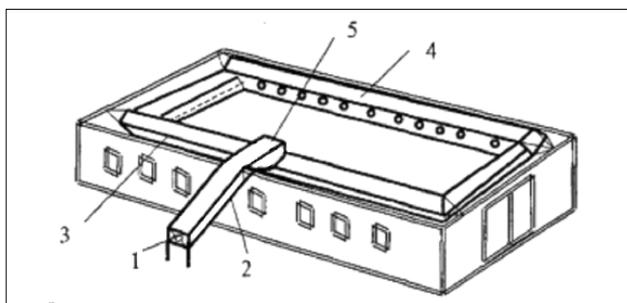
Система установки вентиляции в животноводческом помещении: 1 – наружный вентилятор; 2 – короб; 3 – теплообменный воздуховод; 4 – распределительный воздуховод; 5 – шахта
